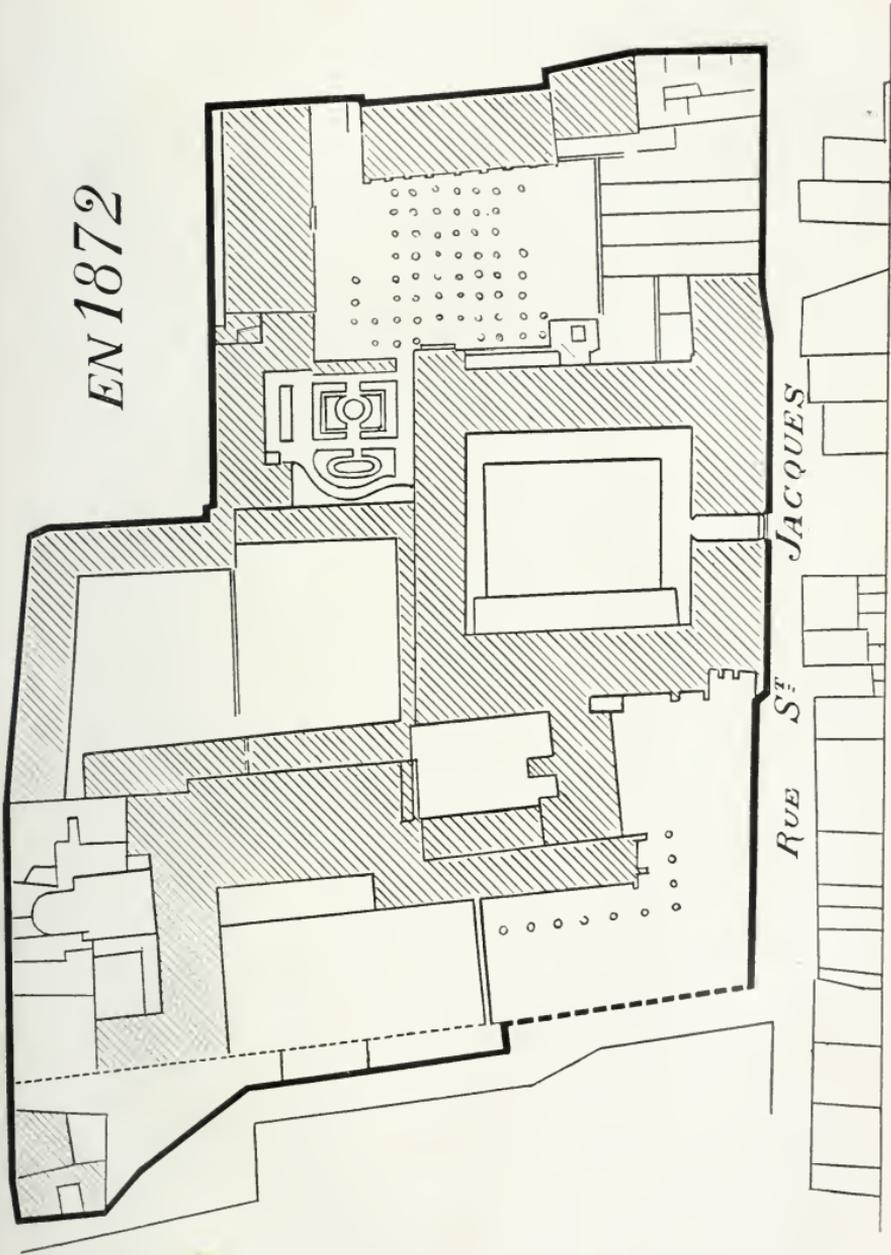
Plan du Lycée en 1872, avant sa reconstruction en 1885-1893.
